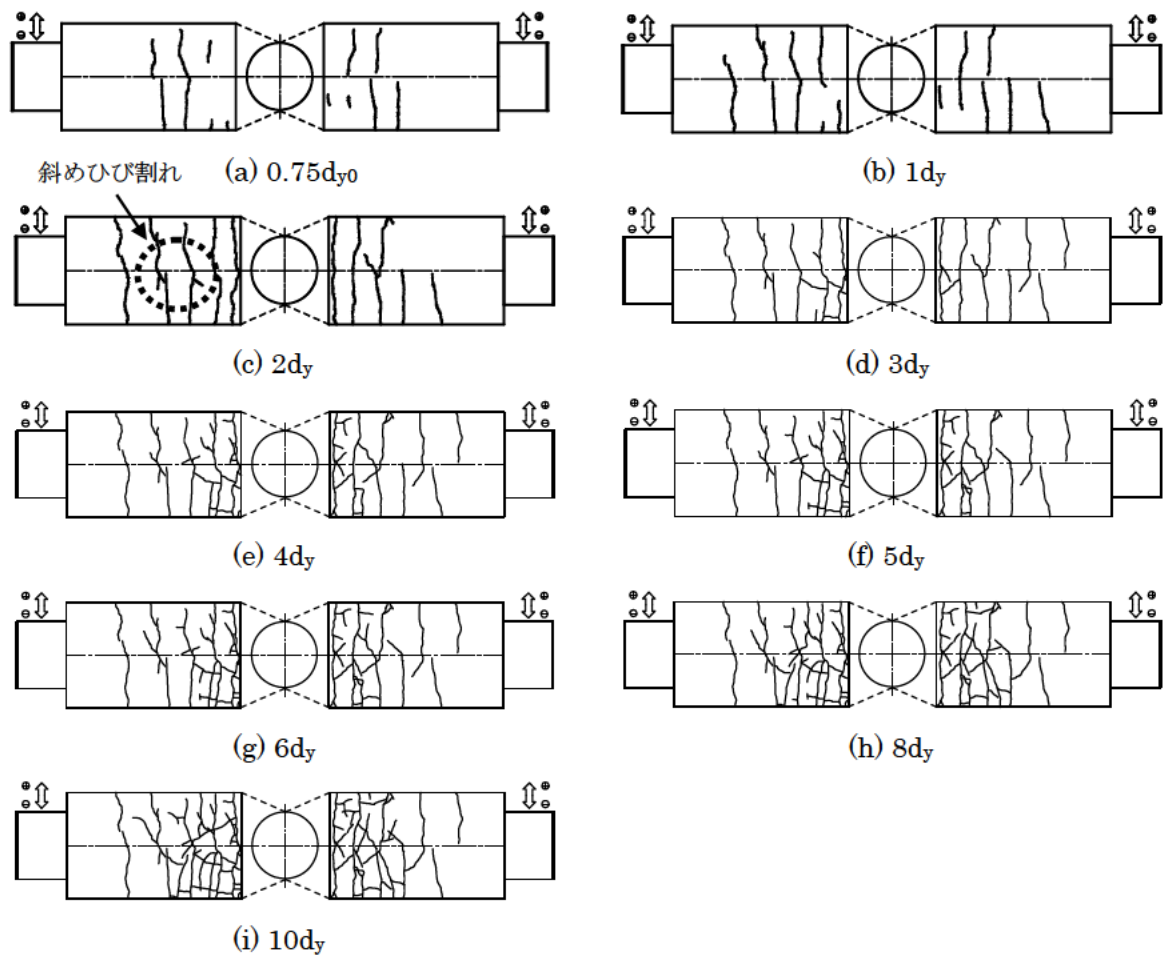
杭体のひび割れ進行状況図 (Case CPP-S-1)
